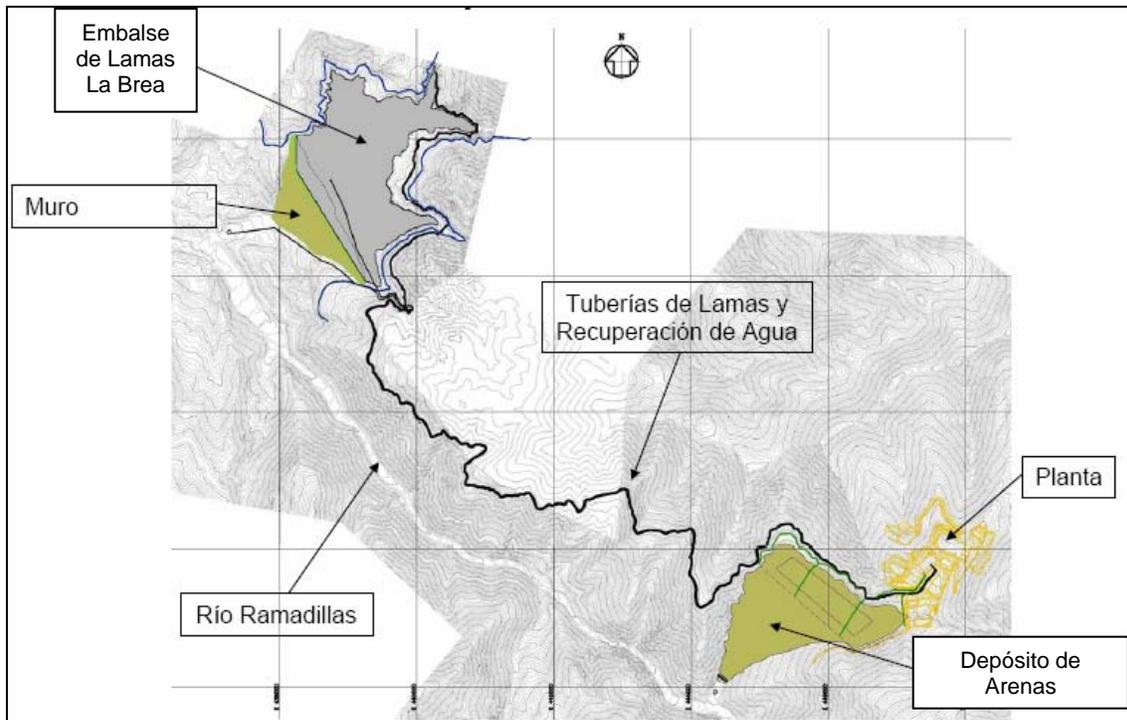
Disposición General en Planta de la Disposición de Relaves.
